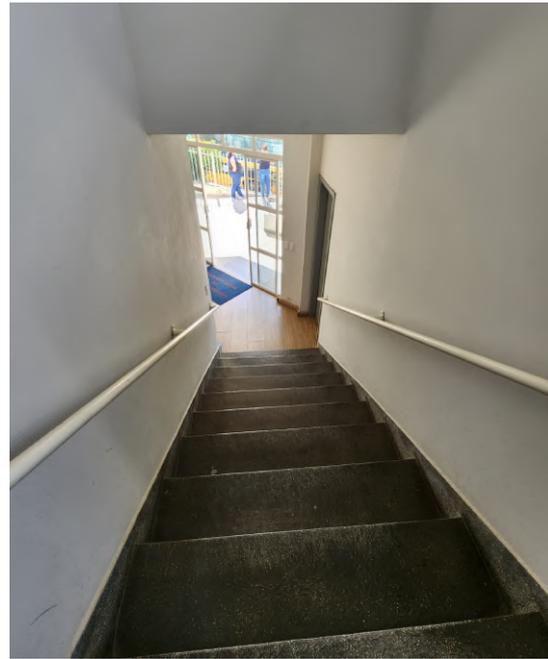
Na escada será realizado uma limpeza das pedras e instalação com sensor de presença no patamar intermediário.
